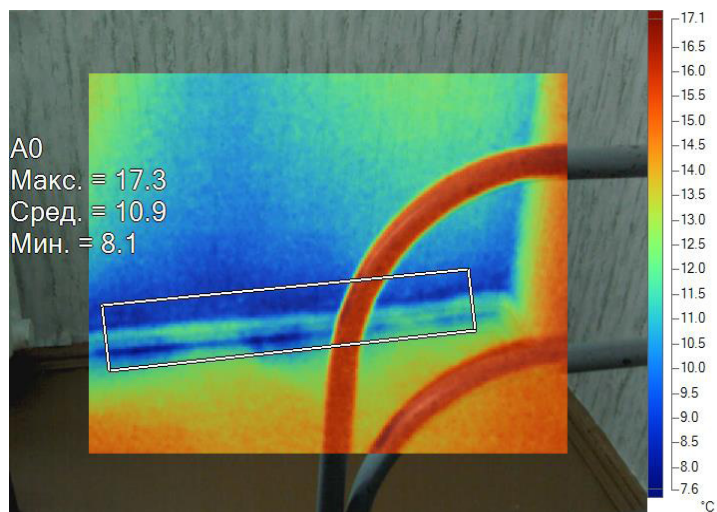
Участок примыкания перекрытий пола и наружной стены комнаты 121
